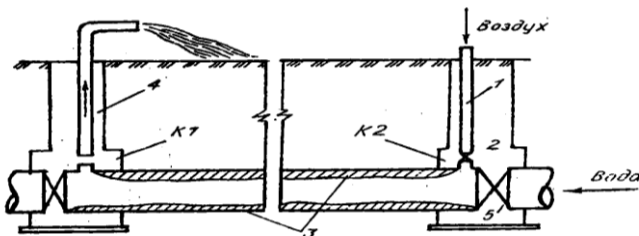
Схема гидропневматической промывки трубопровода: 1 – воздухопровод; 2 – задвижка для впуска воздуха в промываемый участок; 3 – отложения на стенках трубы; 4 – отвод промывной воды; 5 – задвижка.
